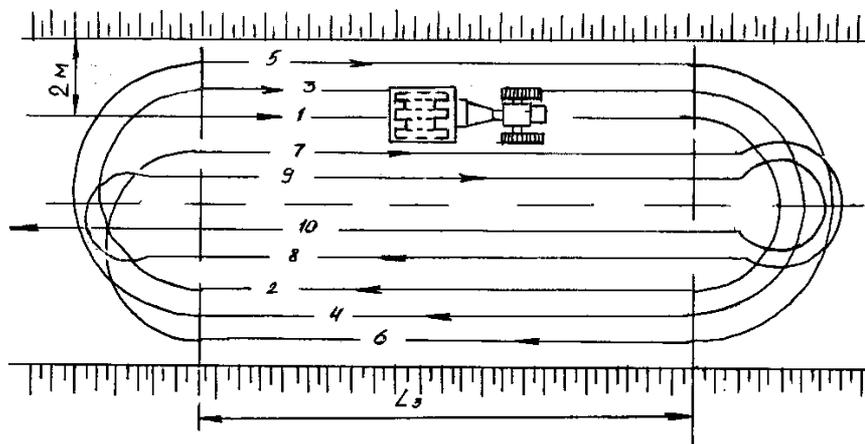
Схема работы прицепного катка на пневматических шинах:
